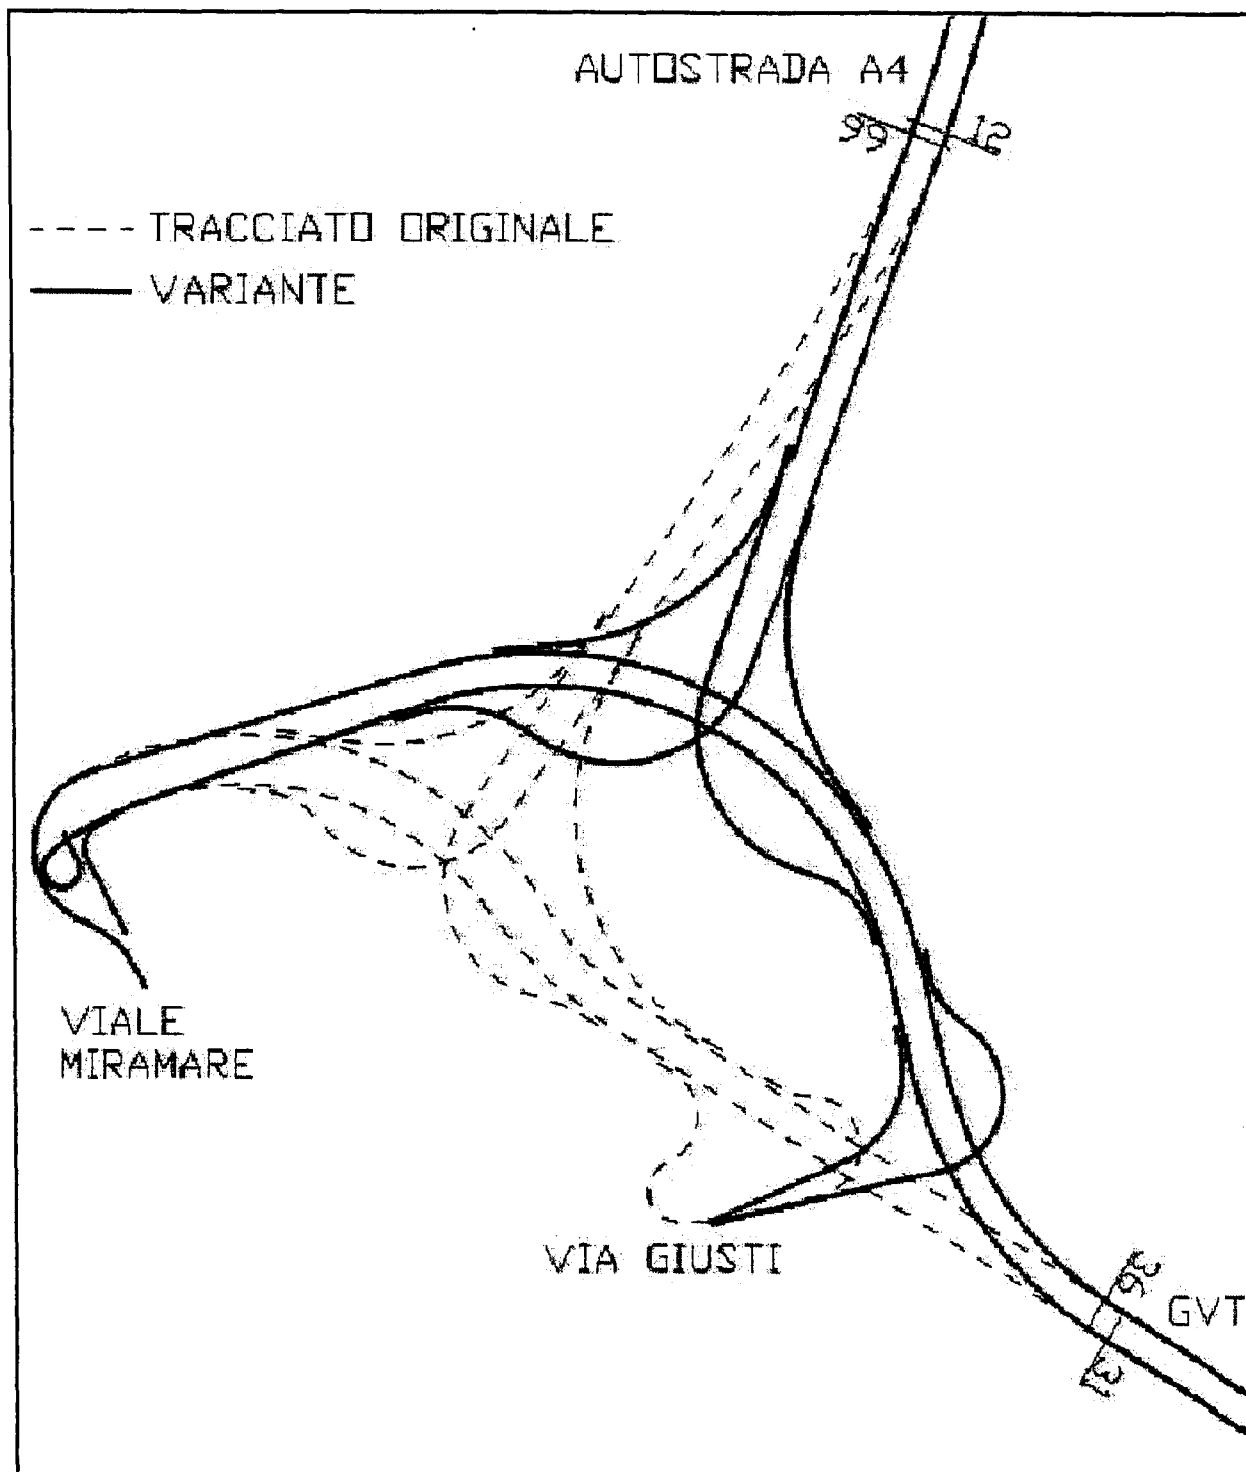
La planimetria del tracciato originale e della variante compatibile con il progetto Italferr
